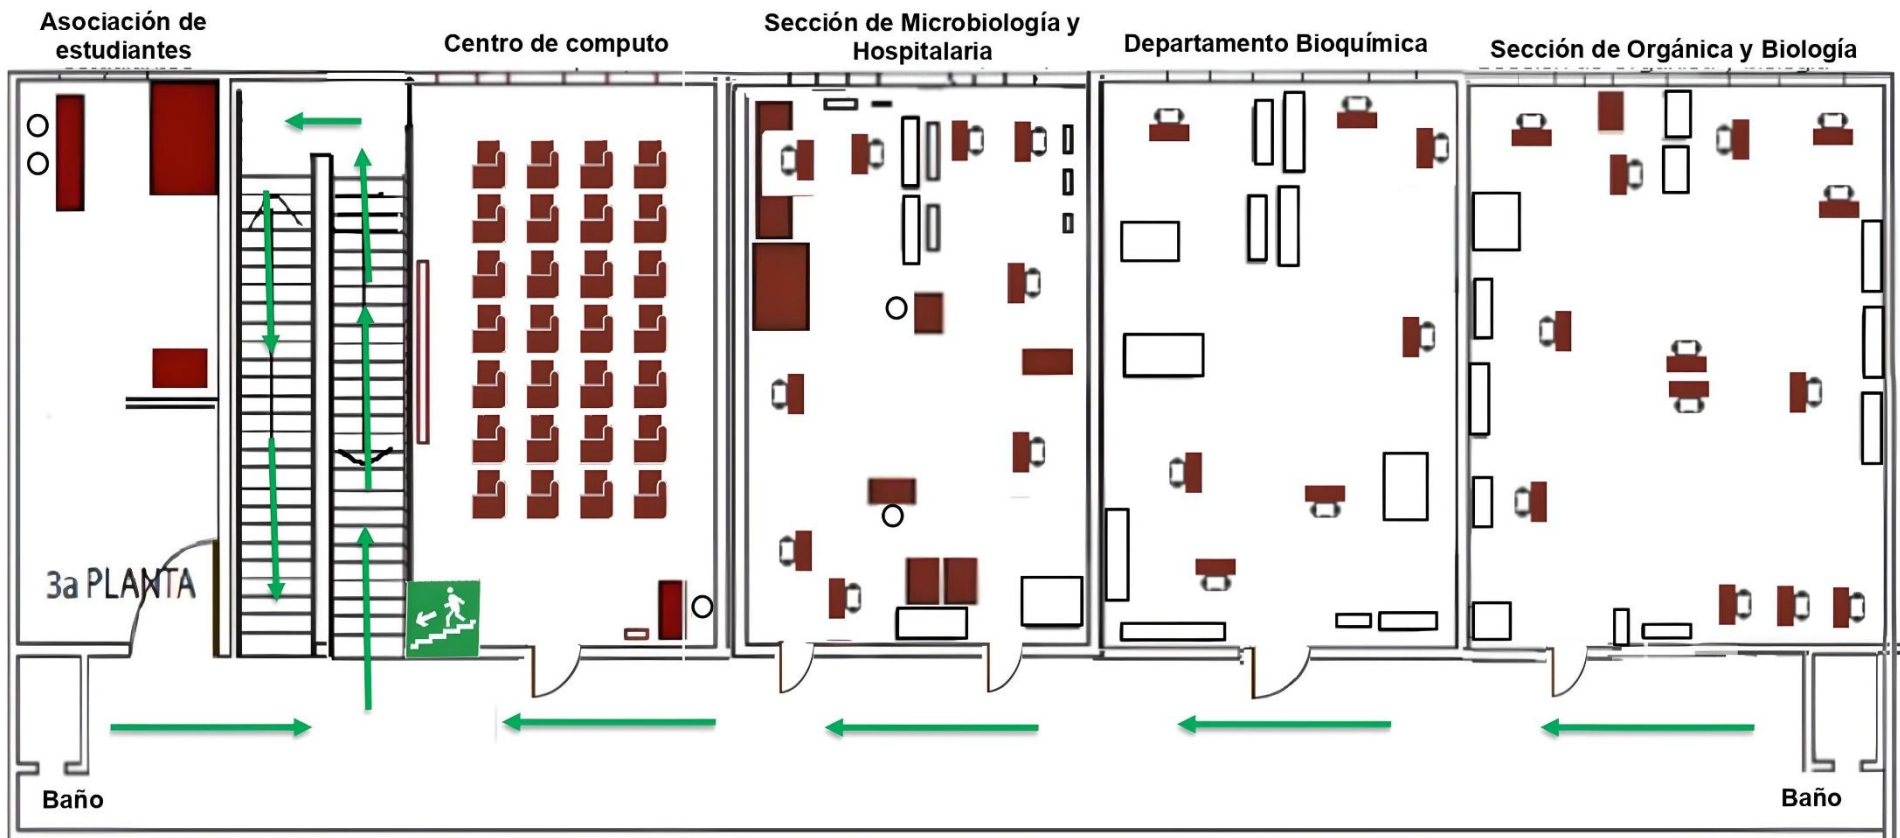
Mapa de riesgo vista en planta (sin escala) tercera planta⁵
